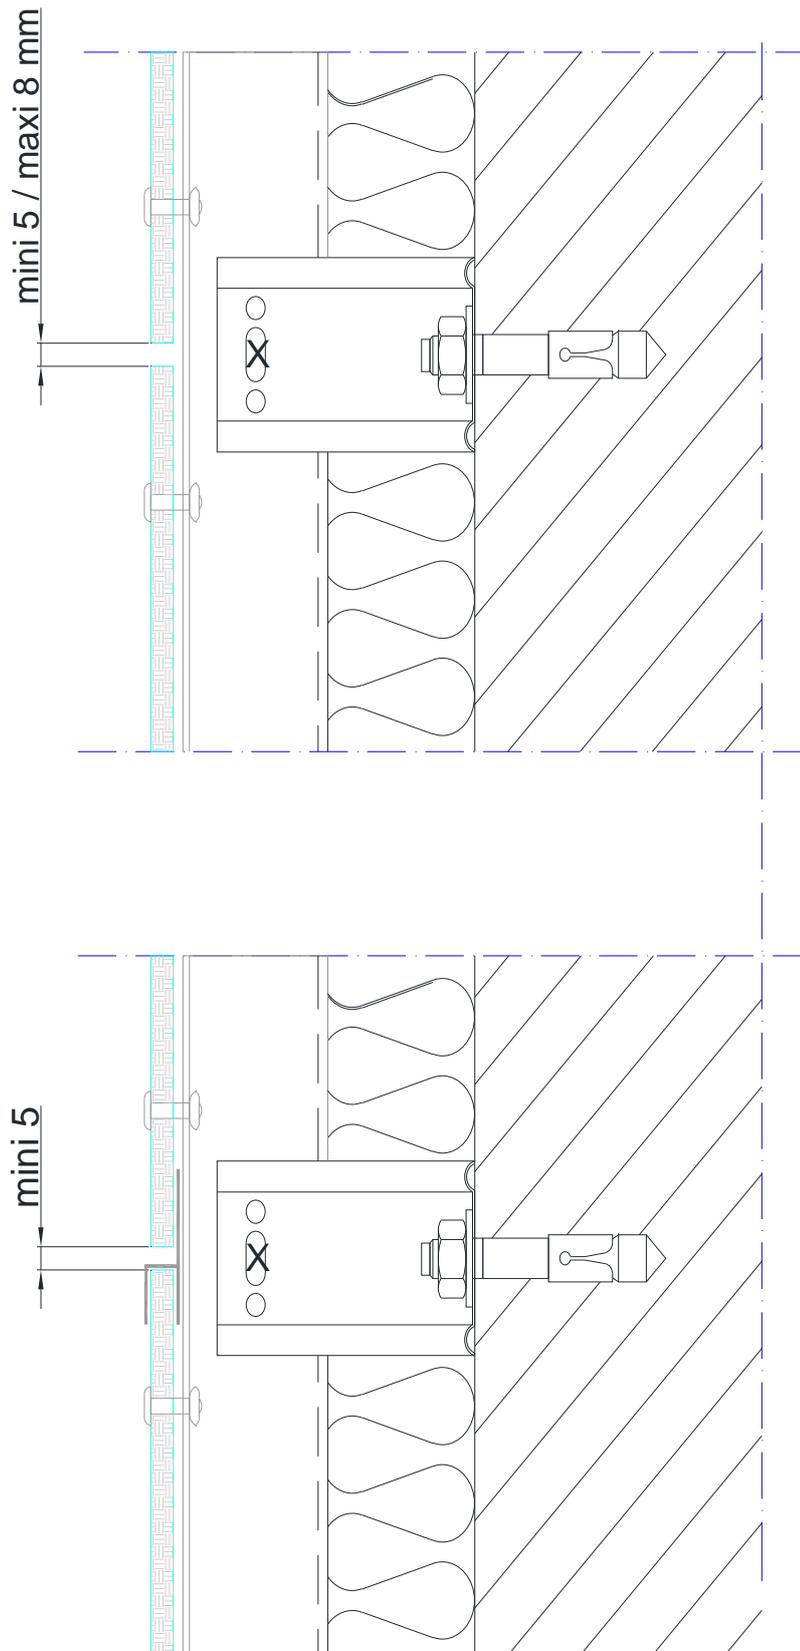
Coupe verticale sur joint horizontal (recouvrement de la lame d'air)
